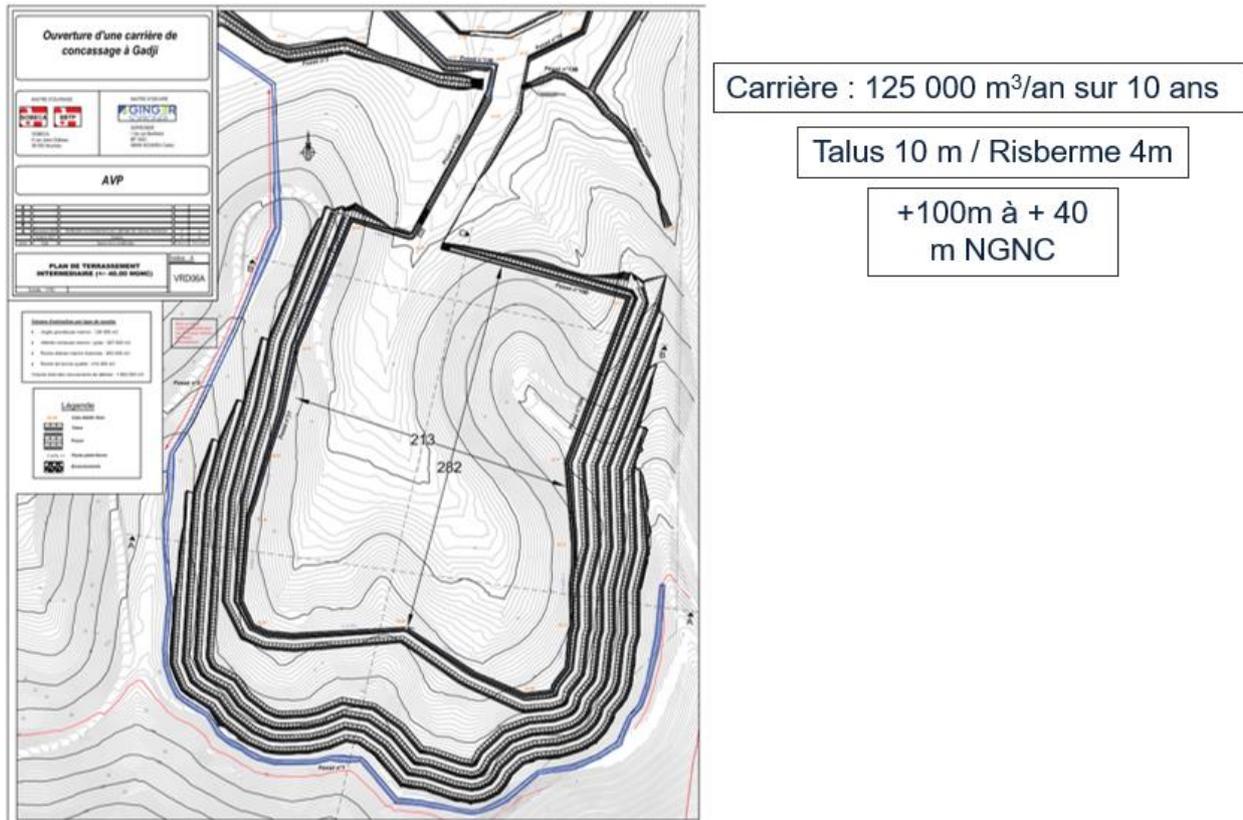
Plan de la zone d'extraction à T₀ + 10 ans
